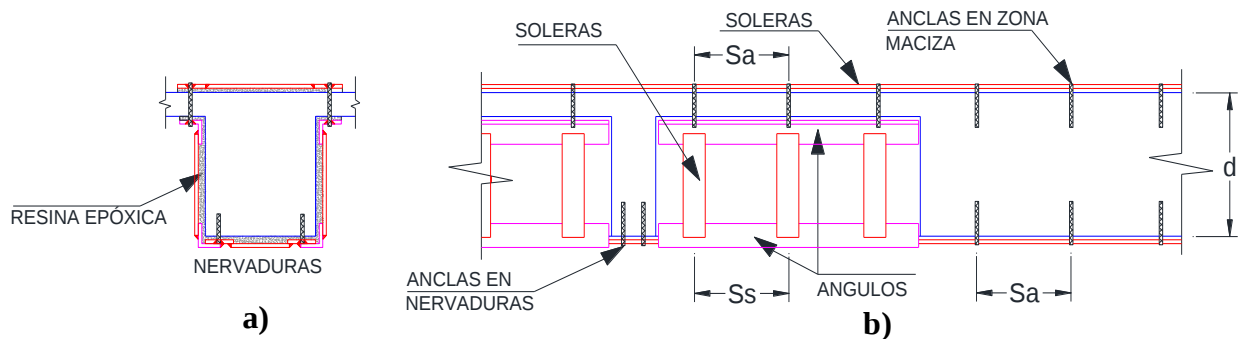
Detalles de refuerzo en las nervaduras y zonas macizas, a) Corte transversal en nervaduras y b) Vista lateral del refuerzo.
